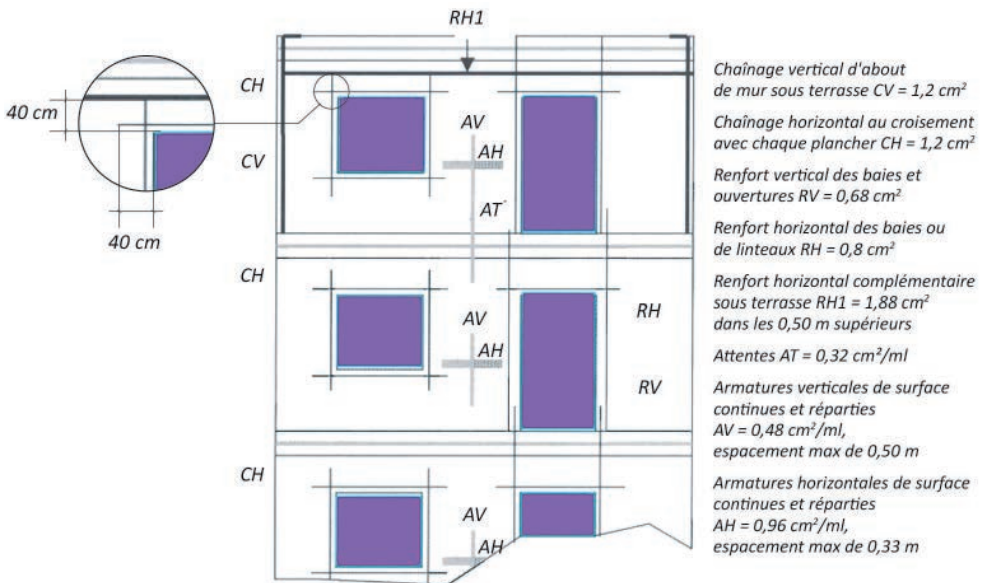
Armatures des voiles extérieurs et autres parois de façade en béton
